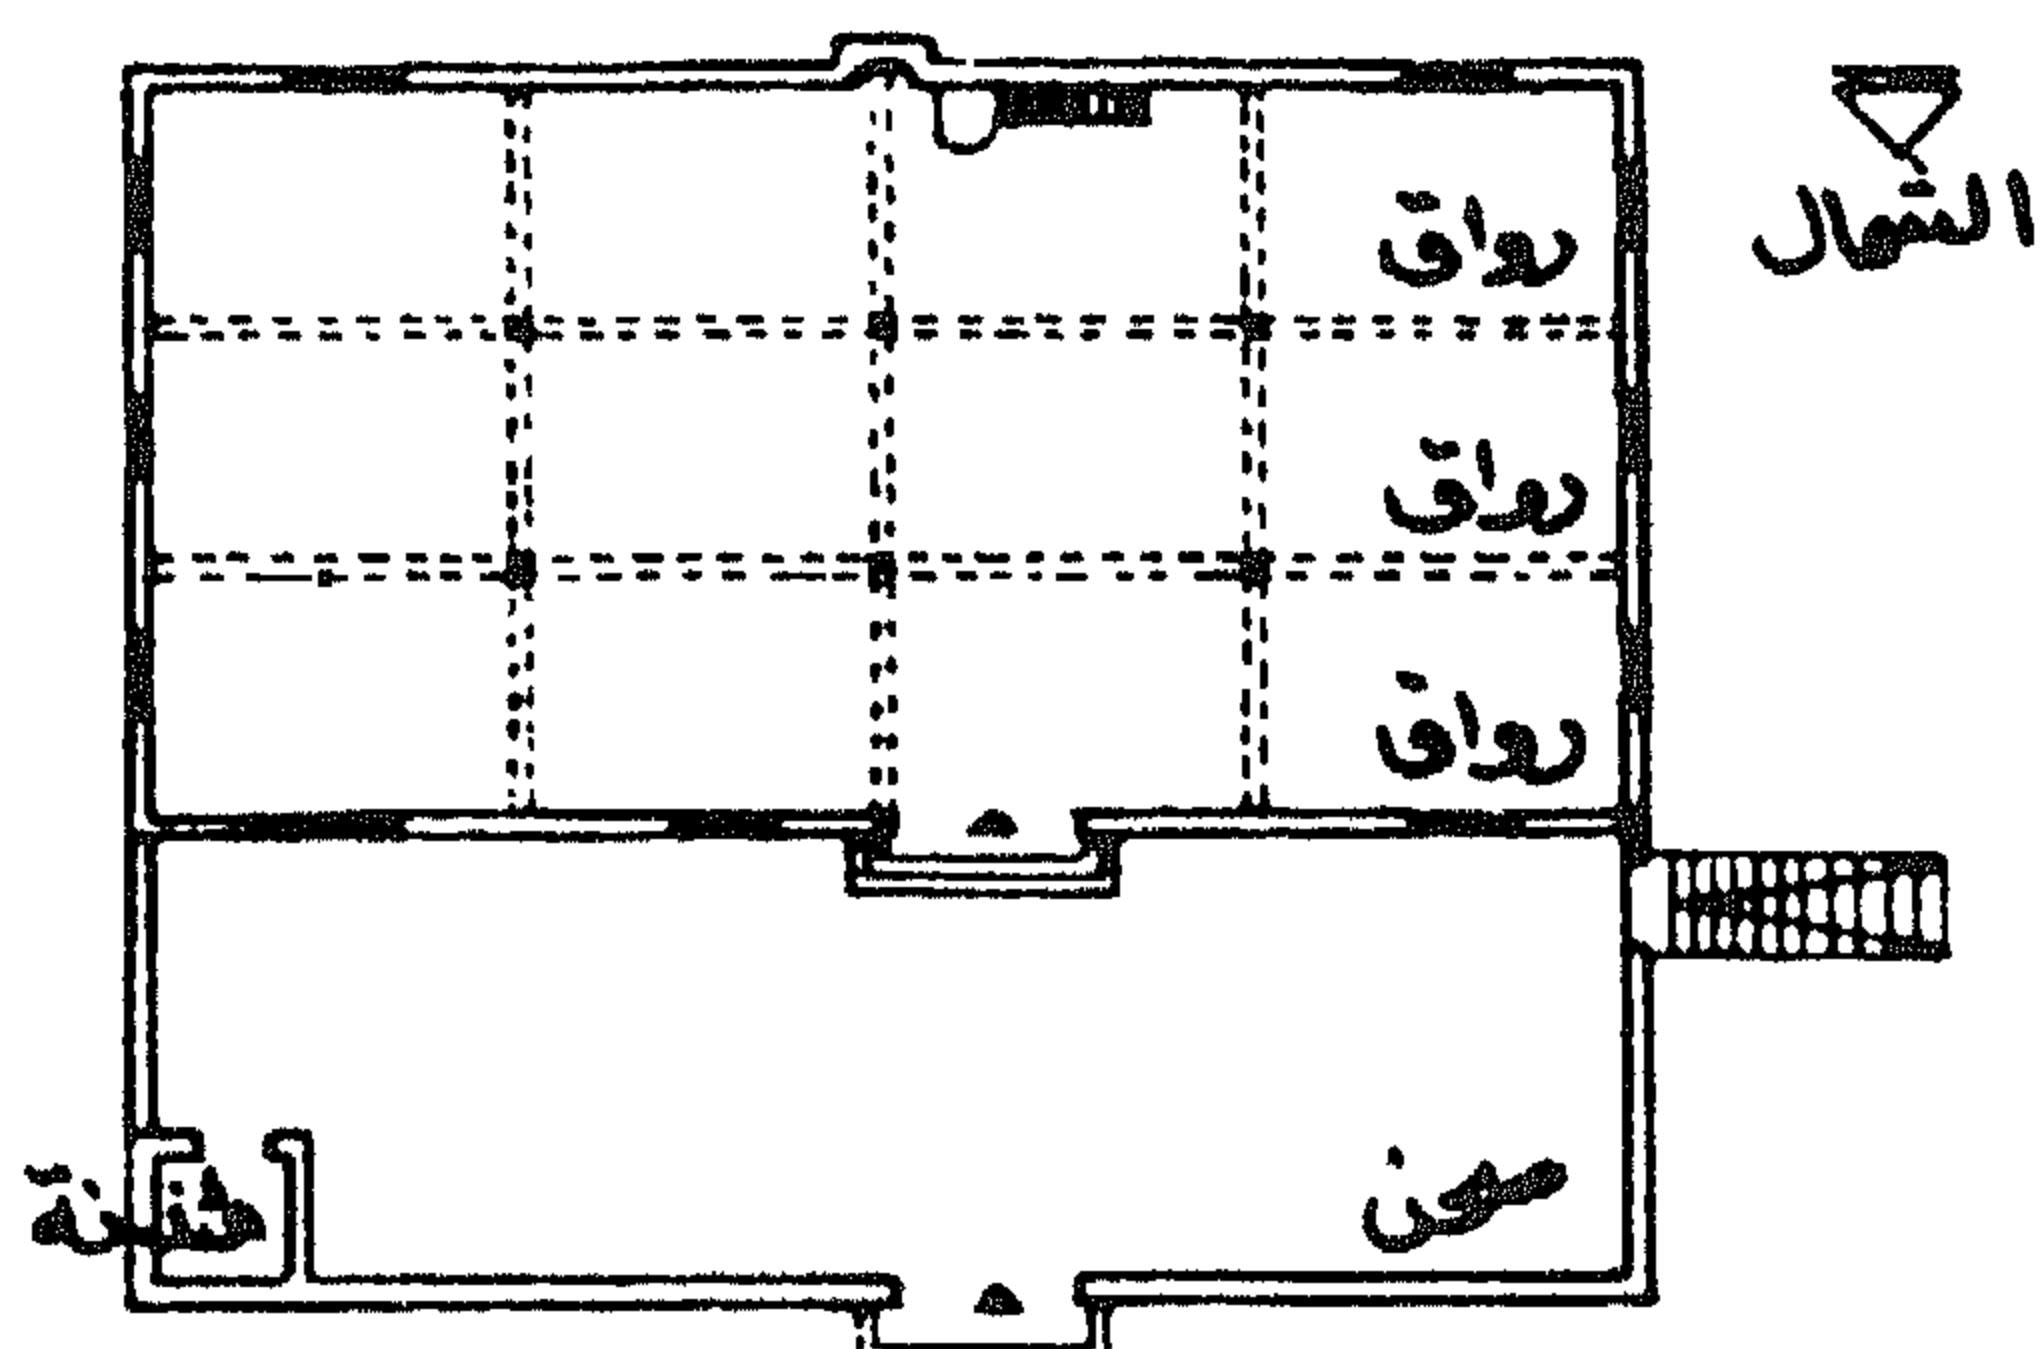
مسقط افقي لمسجد الغمامه بالمدينه المنوره .
